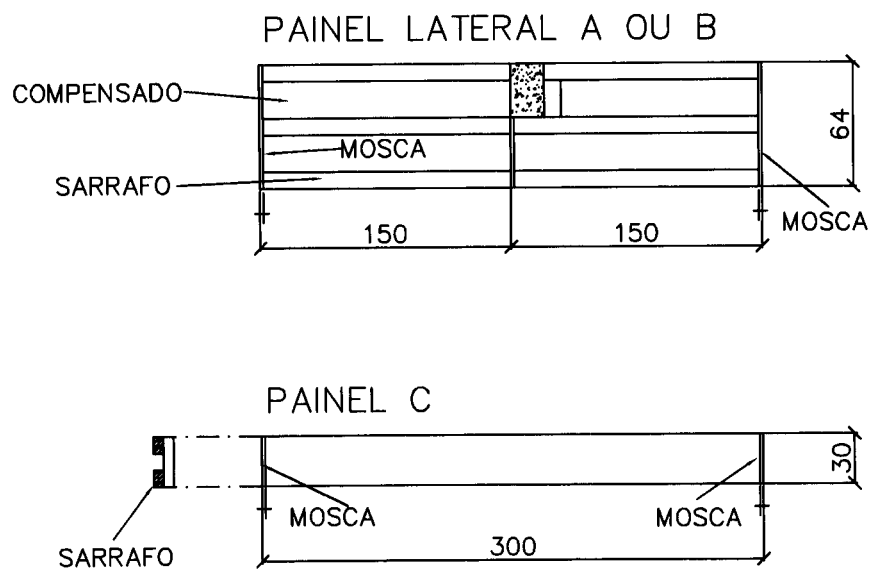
Detalhe dos painéis laterais e de fundo de viga (medidas em cm).
